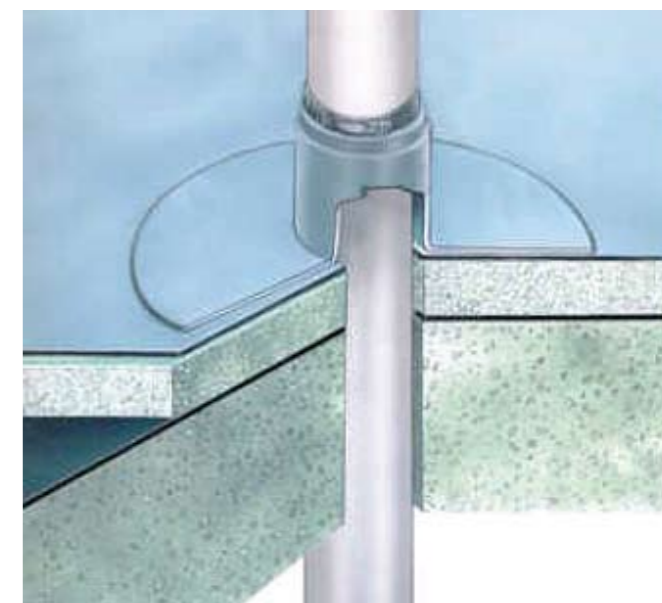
Фасонные элементы для прохода труб.
